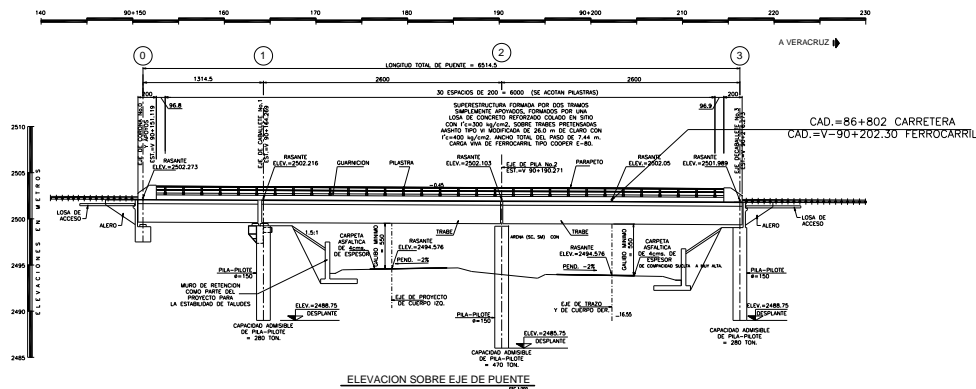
Vista longitudinal del paso de ferrocarril.
